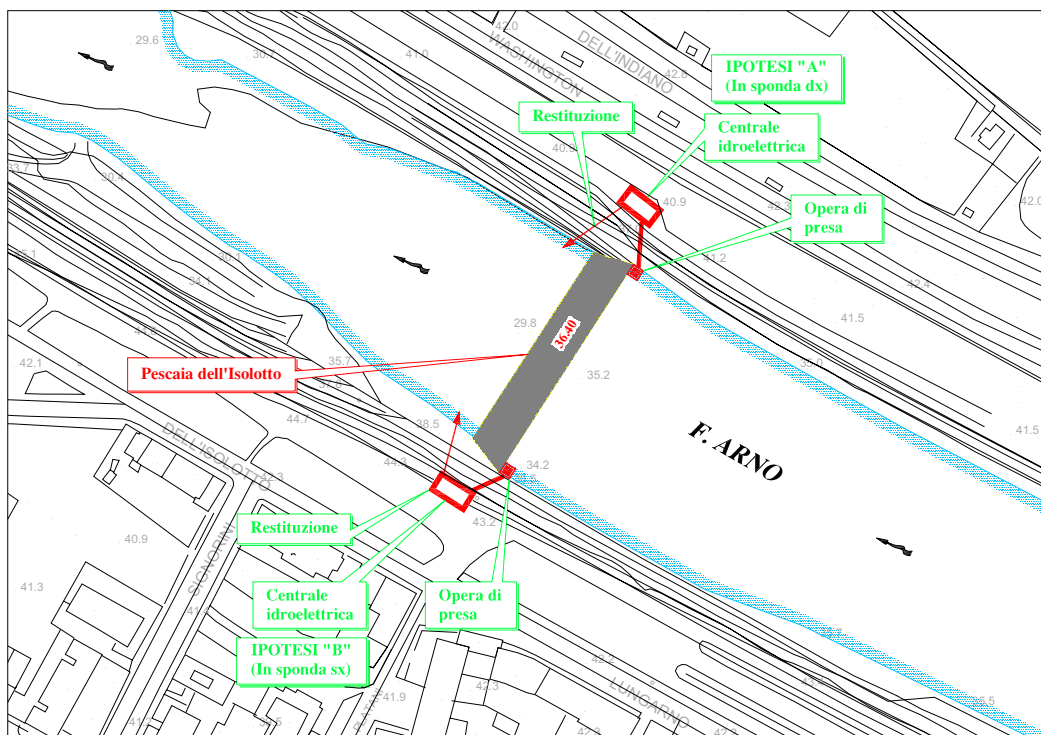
Schema planimetrico della traversa dell'Isolotto e delle possibili centrali (Casagli *et al.*, 2007).
